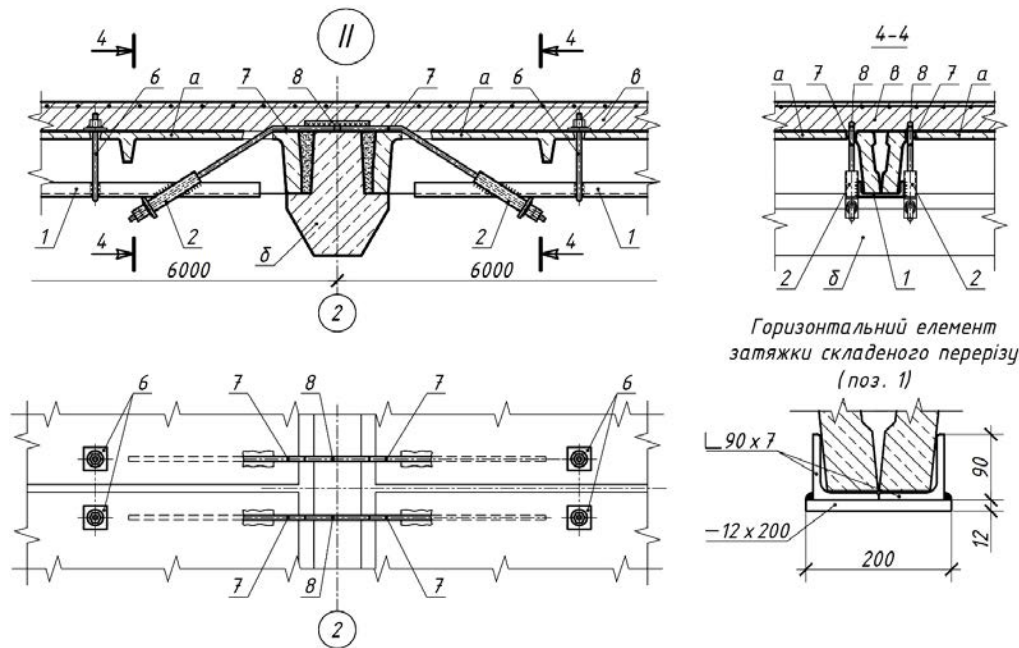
Конструктивне рішення підсилення ребристих плит перекриття на проміжній опорі:
